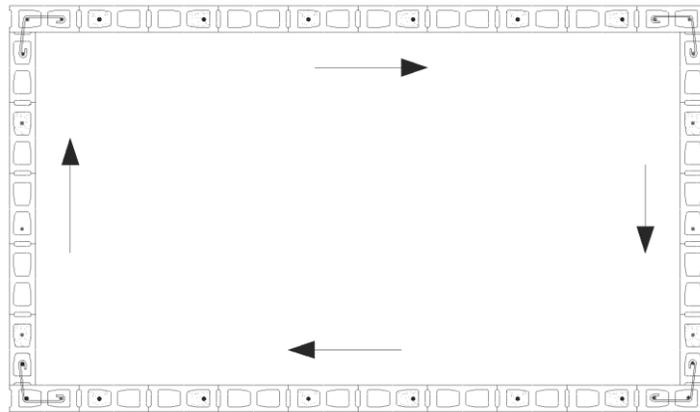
Forma correcta de realizar un levantamiento de mampostería de bloque de concreto
